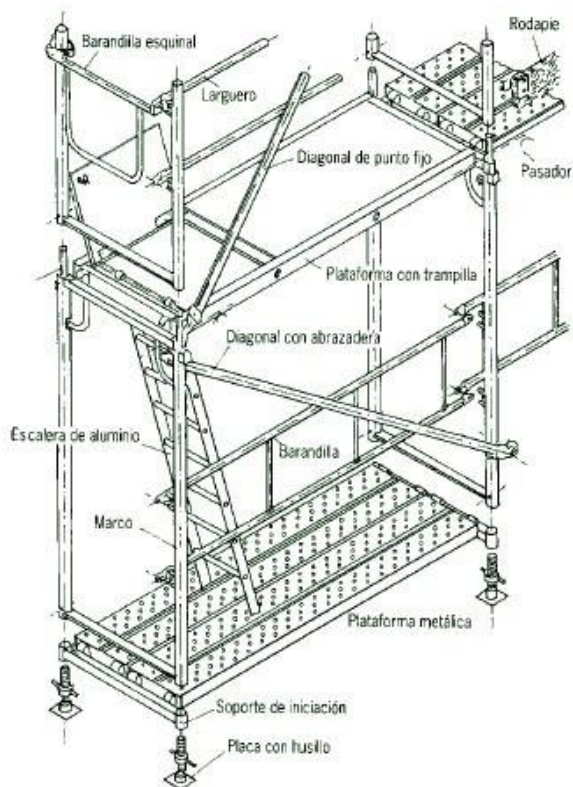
partes de un andamio fijo prefabricado sistema modular
